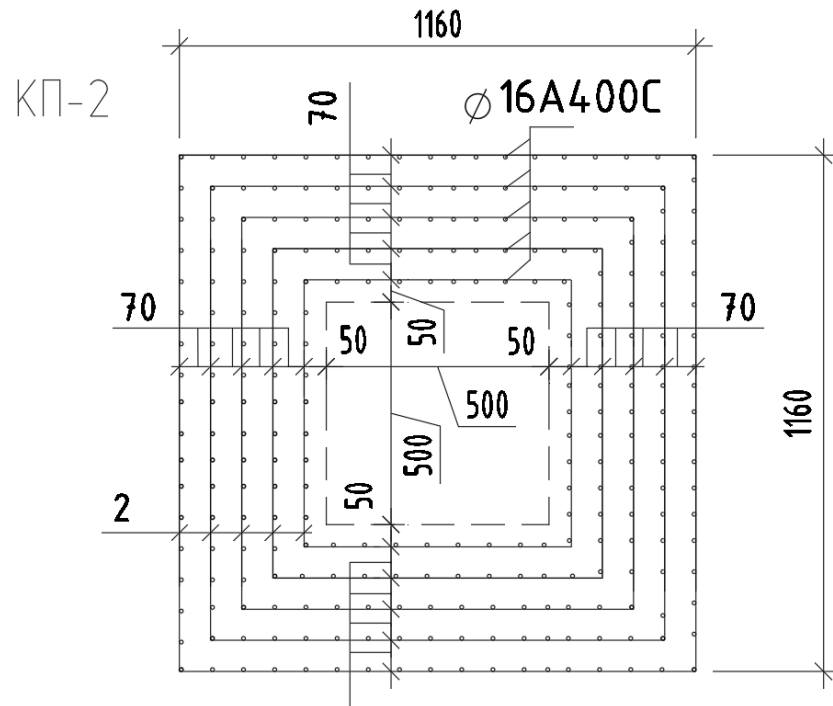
Фрагмент додаткового армування плити перекриття в зоні продавливання
